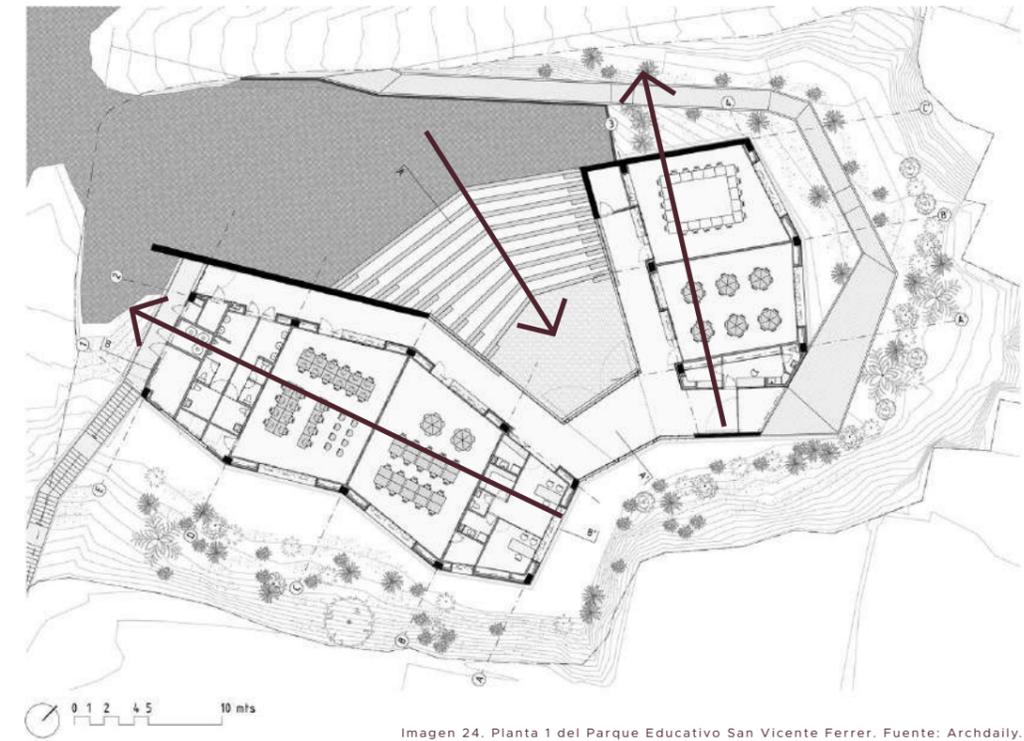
Planta 1 del Parque Educativo San Vicente Ferrer. Fuente: Archdaily.
